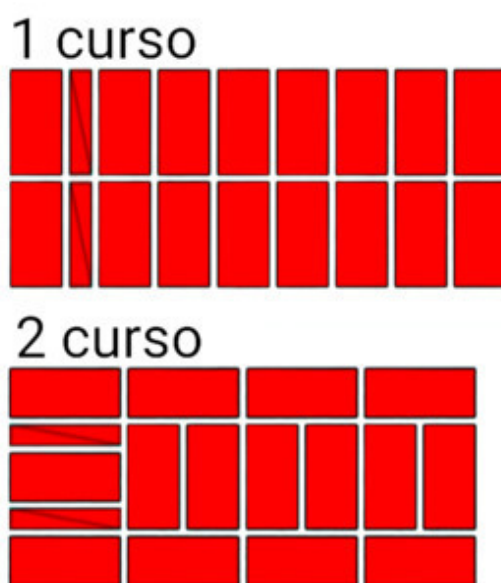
A ordem de colocação de tijolos na restrição vertical da parede de tijolos. Espessura da parede 2 tijolos.
